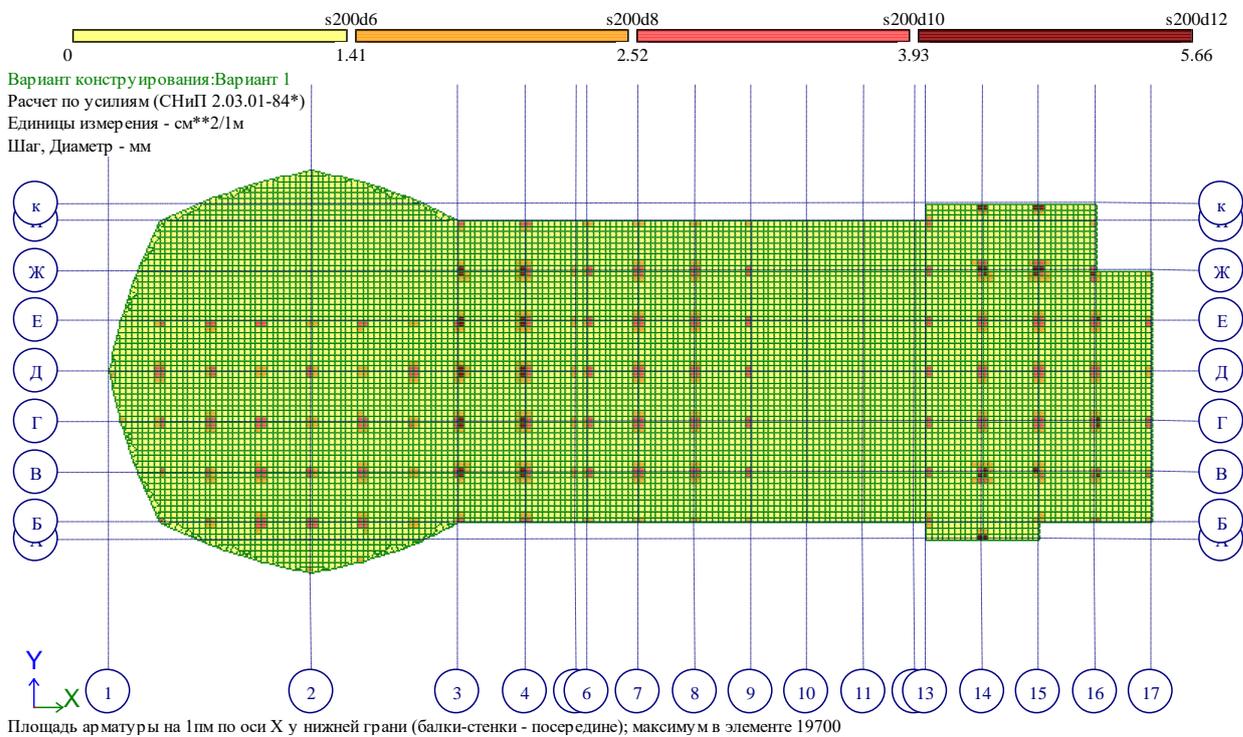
Площадь арматуры по оси X у нижней грани
